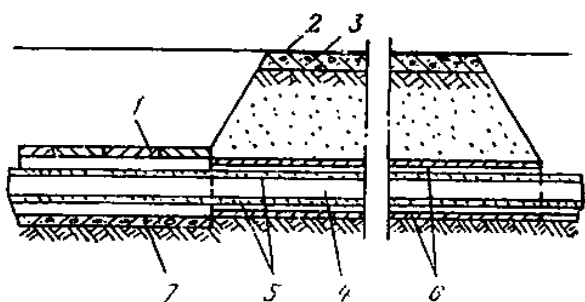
Пересечение теплопроводами дорожной или железнодорожной насыпи:
